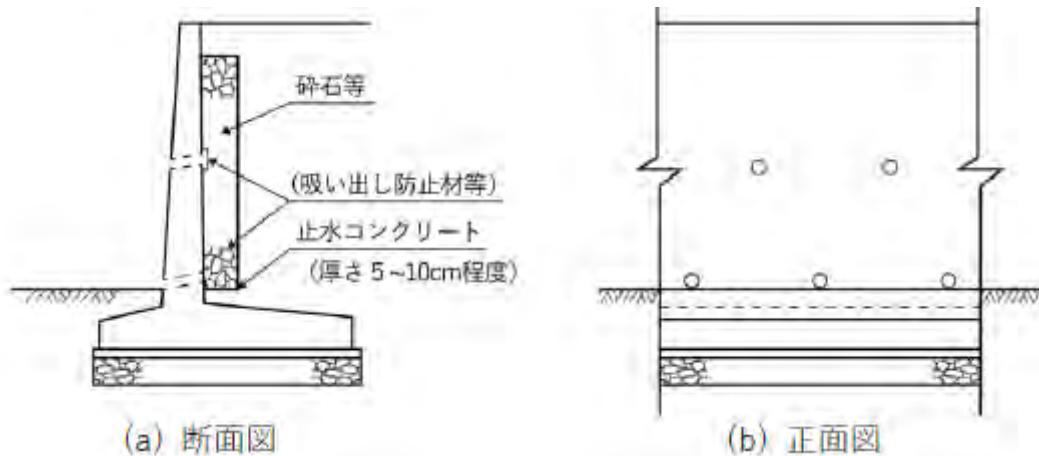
鉄筋コンクリート擁壁の断面図及び水抜穴設置図
